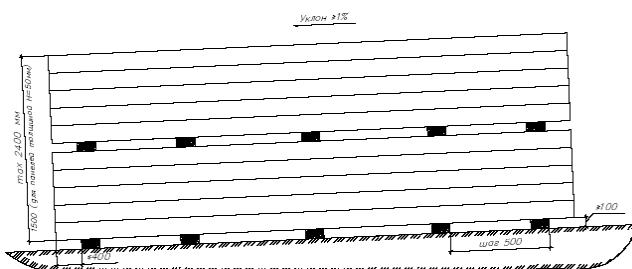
Схема складирования пакетов стеновых и кровельных панелей
